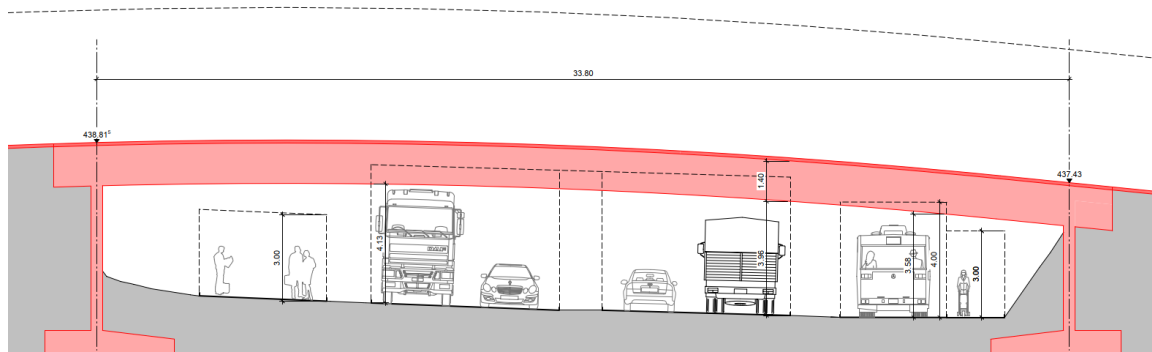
, Planausschnitt: Variante einfacher Balken, Florian Sutter
